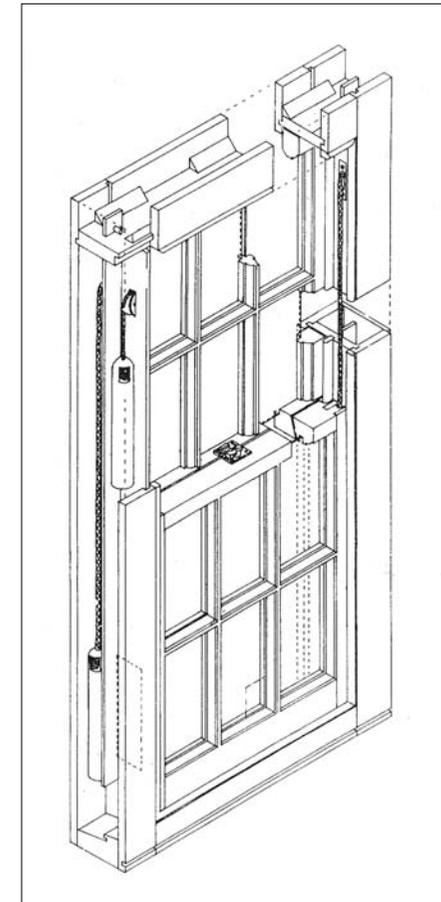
Konstruktiver Aufbau eines traditionellen Vertikalschiebefensters mit Gegengewicht (sash-window)
